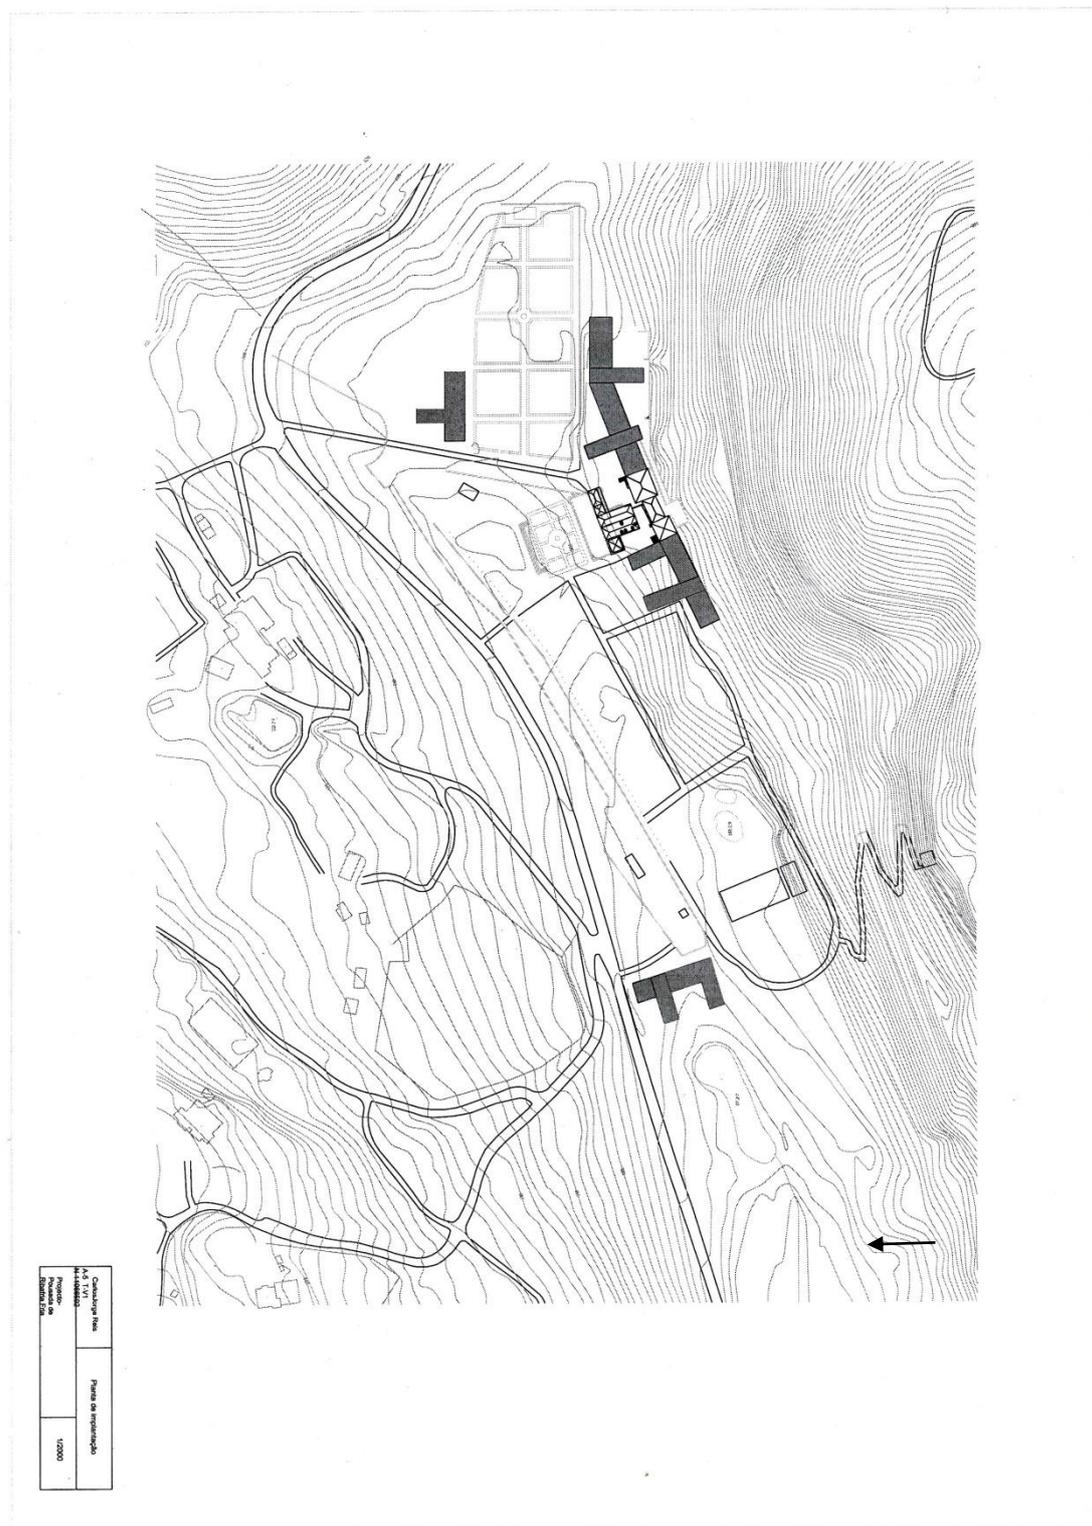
Planta da implantação do projeto da Pousada de Ribafria
